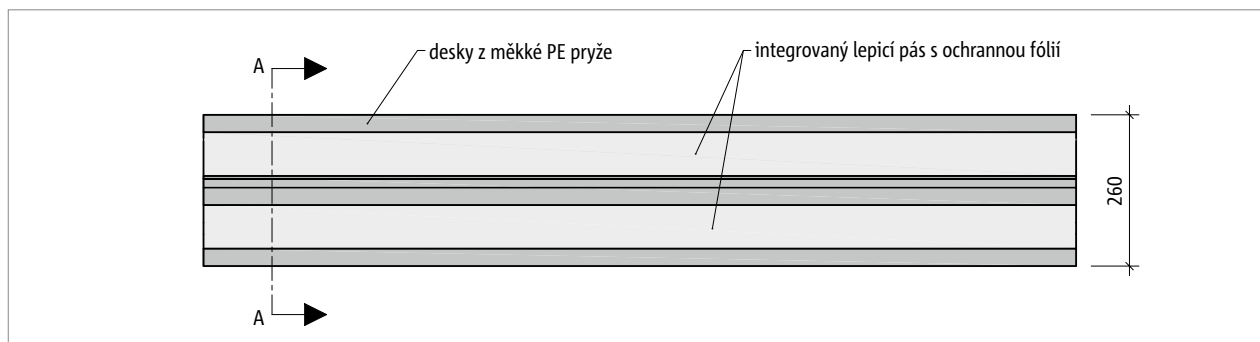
Schöck Tronsole® typ F: Uspořádání prvků – detail B
